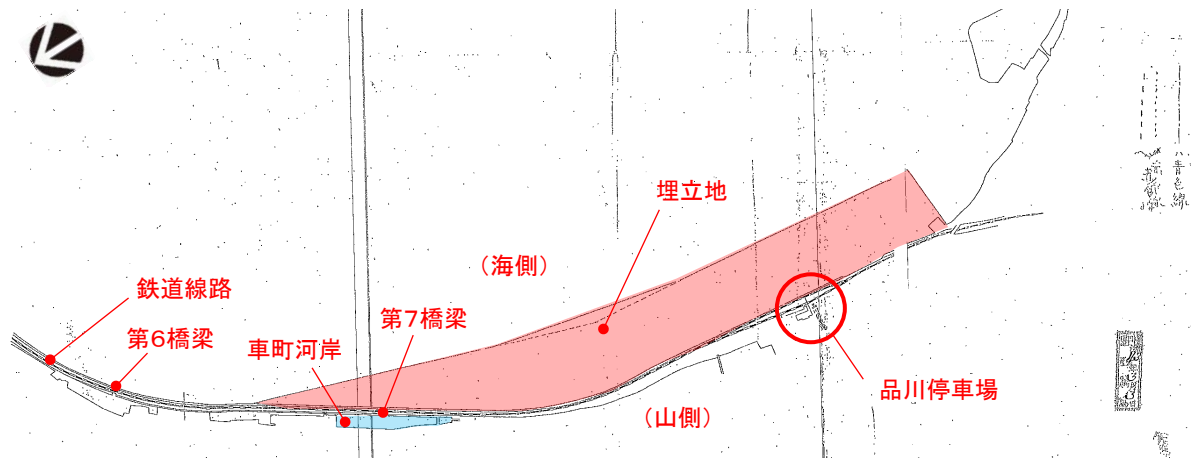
品川停車場付近平面図 (都公文 302. B5. 20)
